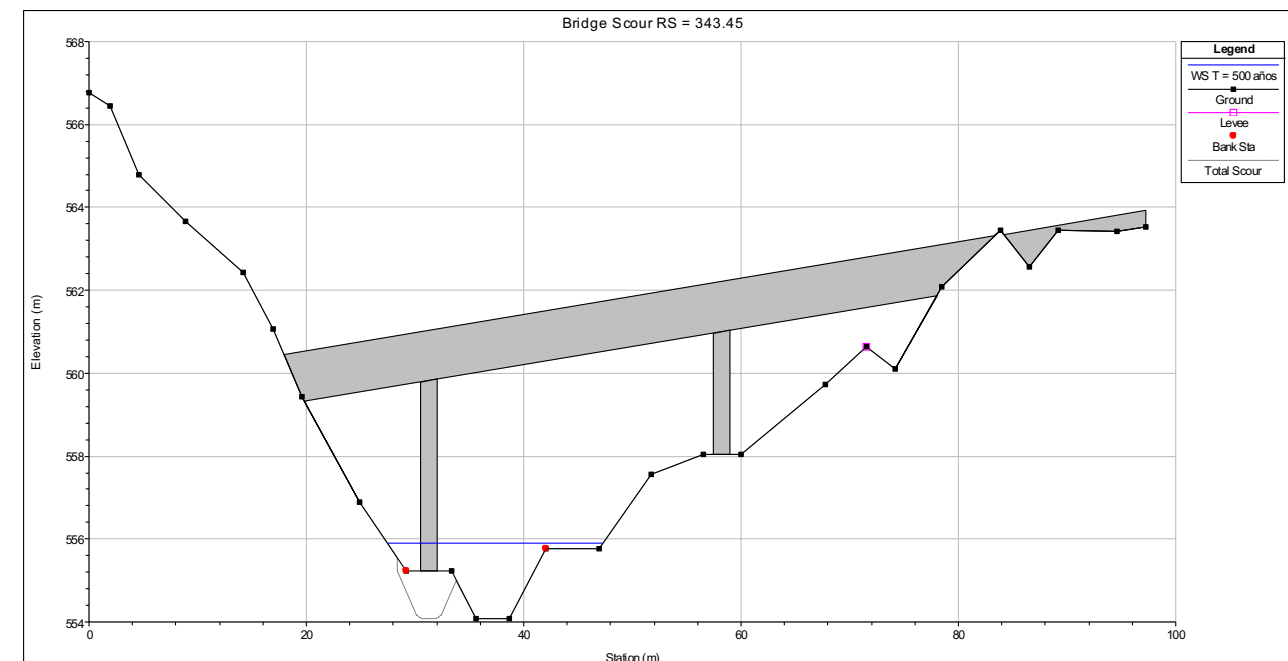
Alternativa Centro, puente sobre el barranco del Montú. Regularización de la sección transversal del tramo a proteger (60 m) y socavación local en pilas. (HEC-RAS).
